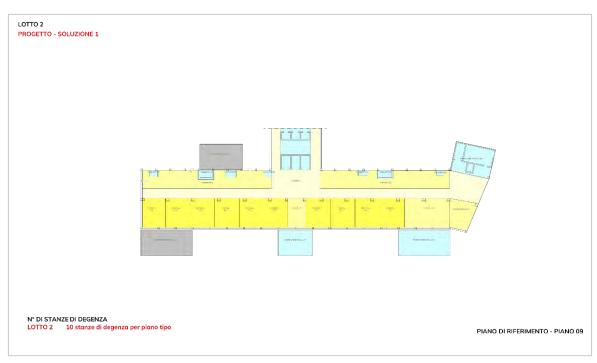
PROGETTO PIANO TIPO LOTTO 2 - SOLUZIONE 1
